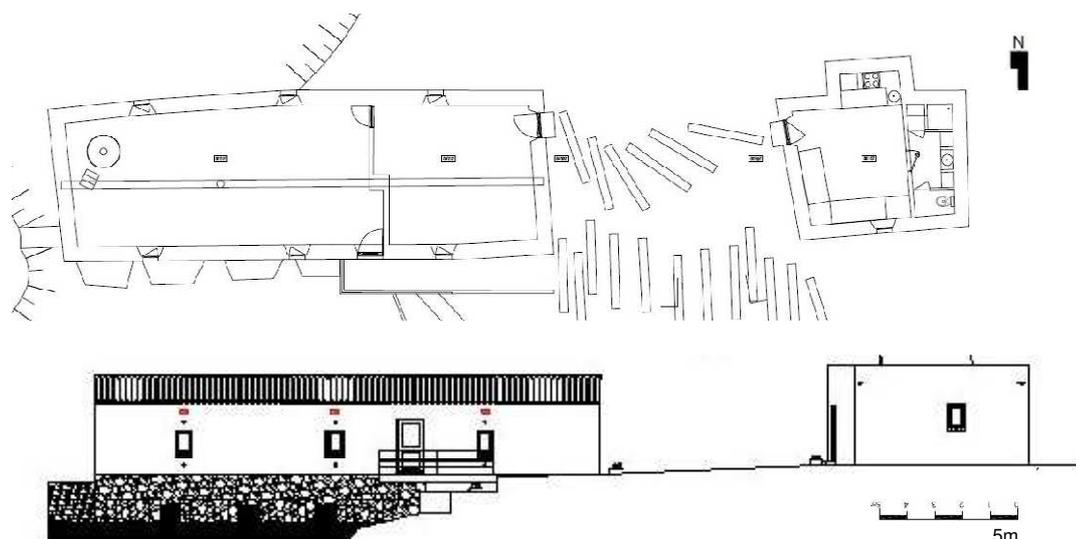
À esquerda, em cima: planta de coberturas do moinho e anexo; em baixo: alçado norte (arq. Lopes da Costa; desenhos à Esc. 1/100).
